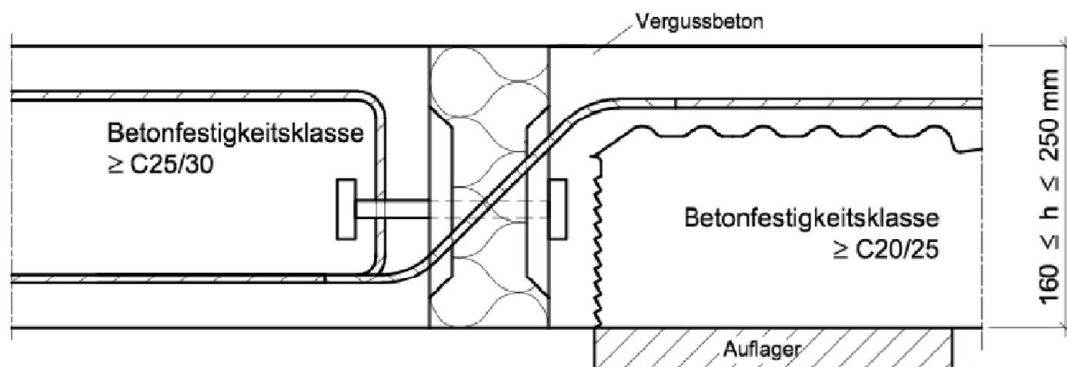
Beispiel Schöck Isokorb® Typ Q-ID mit Stahldrucklager in eingebautem Zustand mit Vergussfuge
